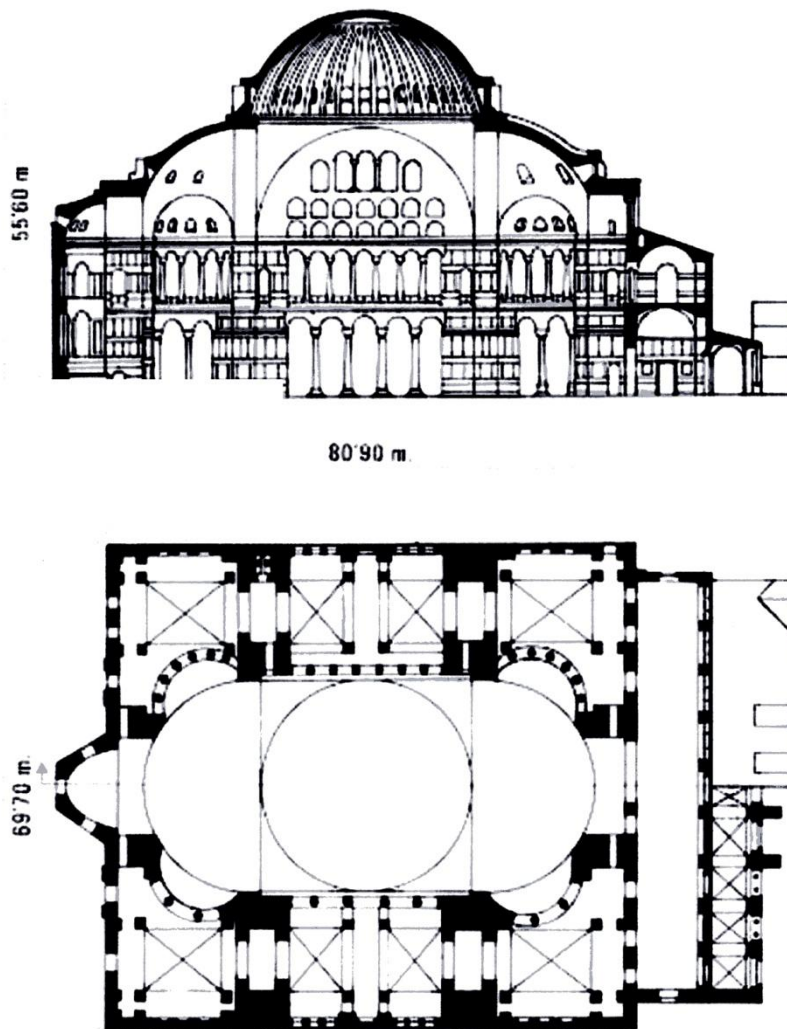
Planta y sección de Santa Sofía. (D. P.)
